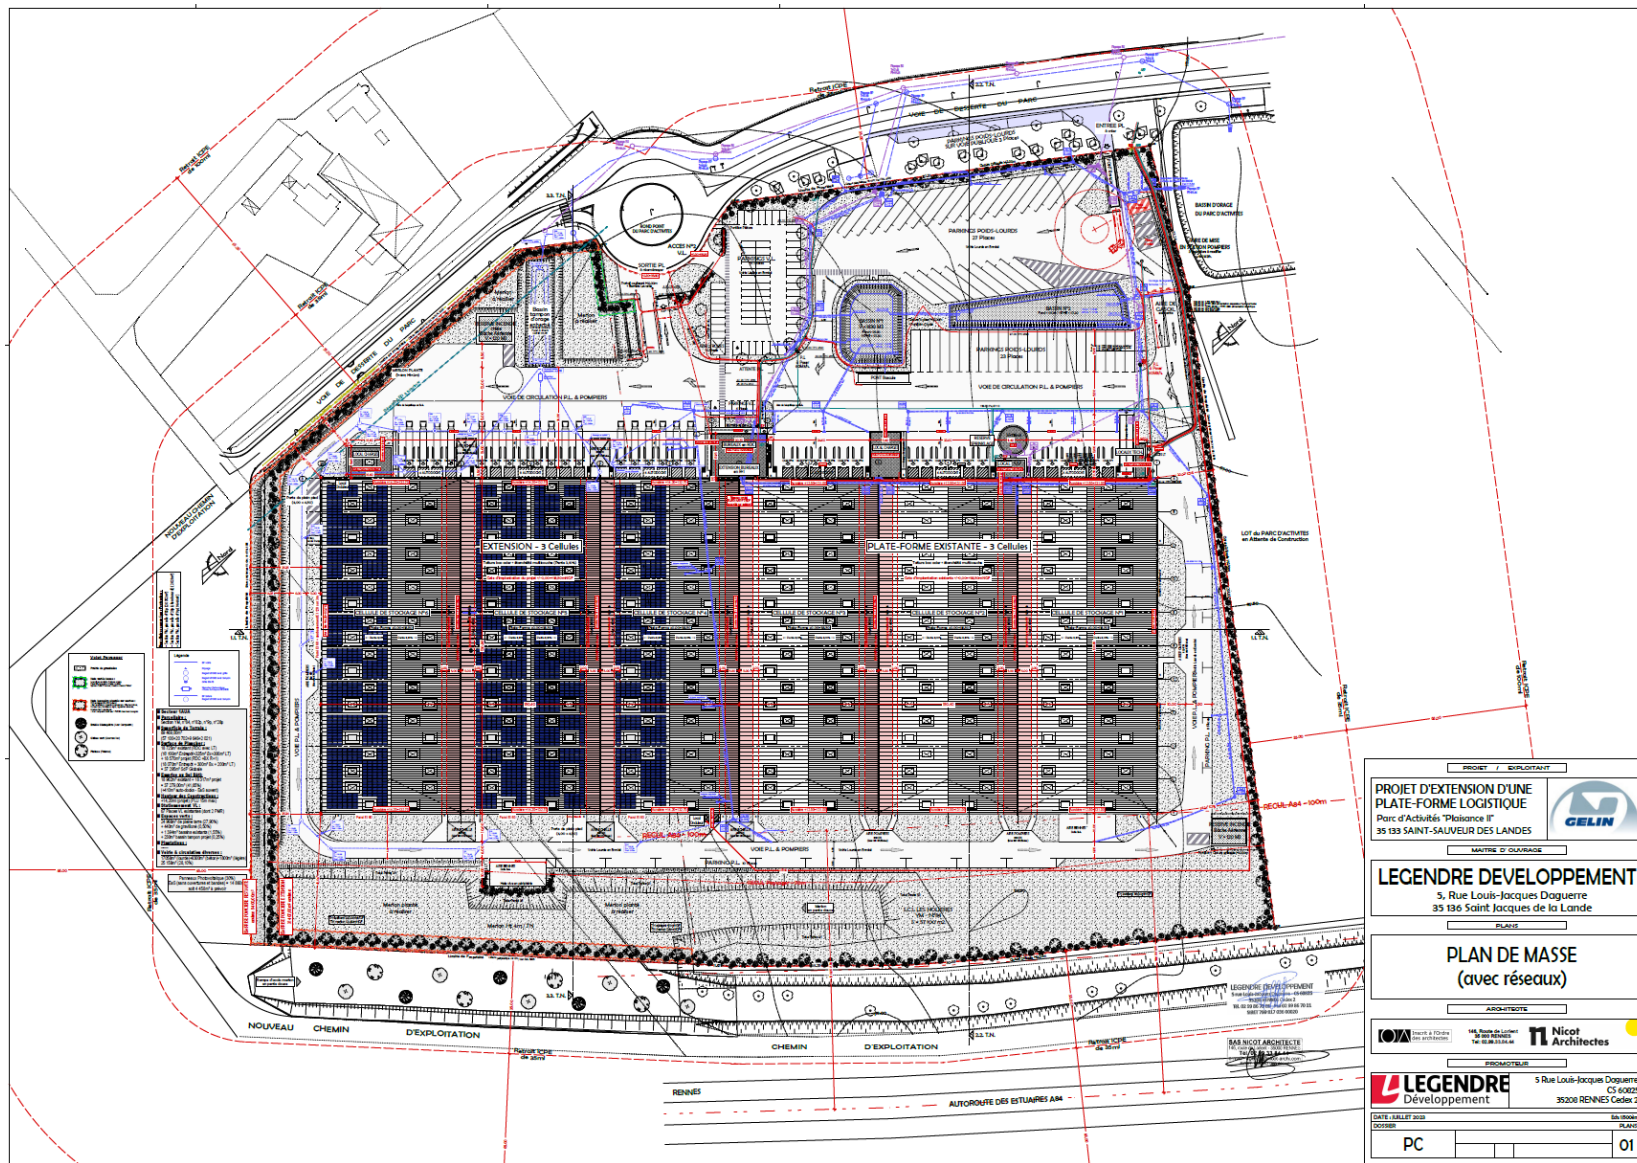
Plan de masse (source : NICOT ARCHITECTE)
